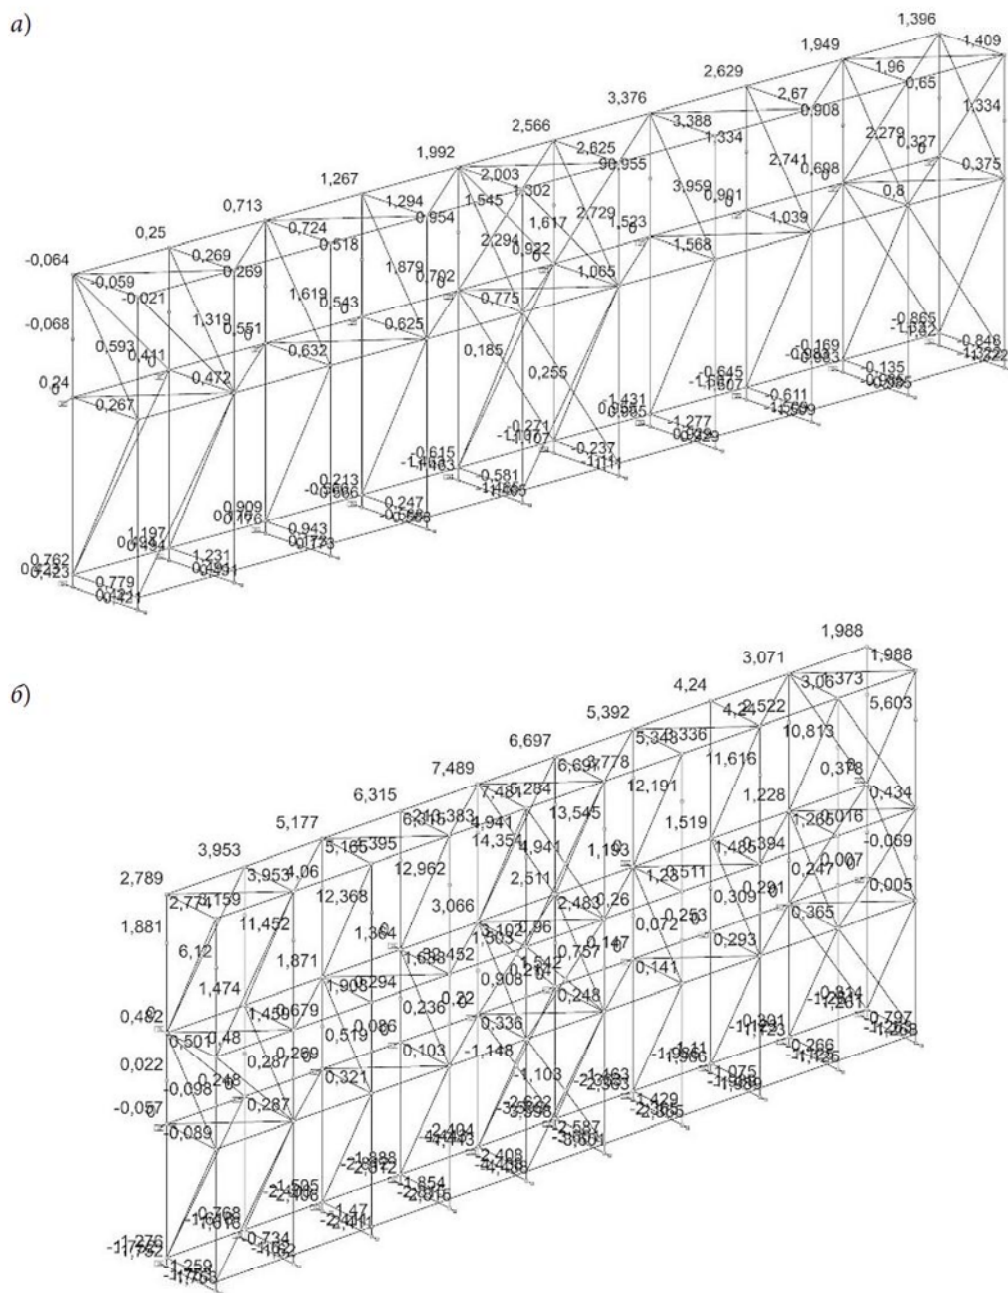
Перемещения узлов защитного экрана, мм: а — на I этапе производства строительно-монтажных работ; б — на II этапе производства строительно-монтажных работ
